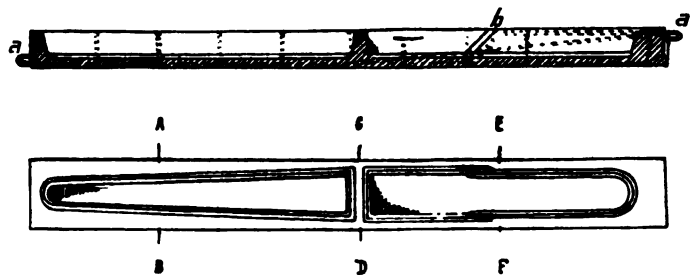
u. 350. Eisenarmierte Betonbalken, System Grevé.
